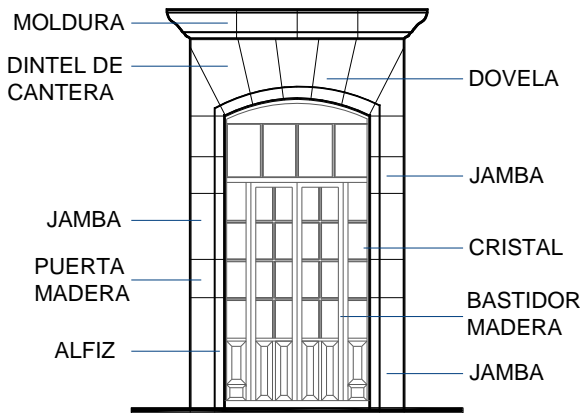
Vista de la puerta de acceso de la sala - estudio de la vivienda
